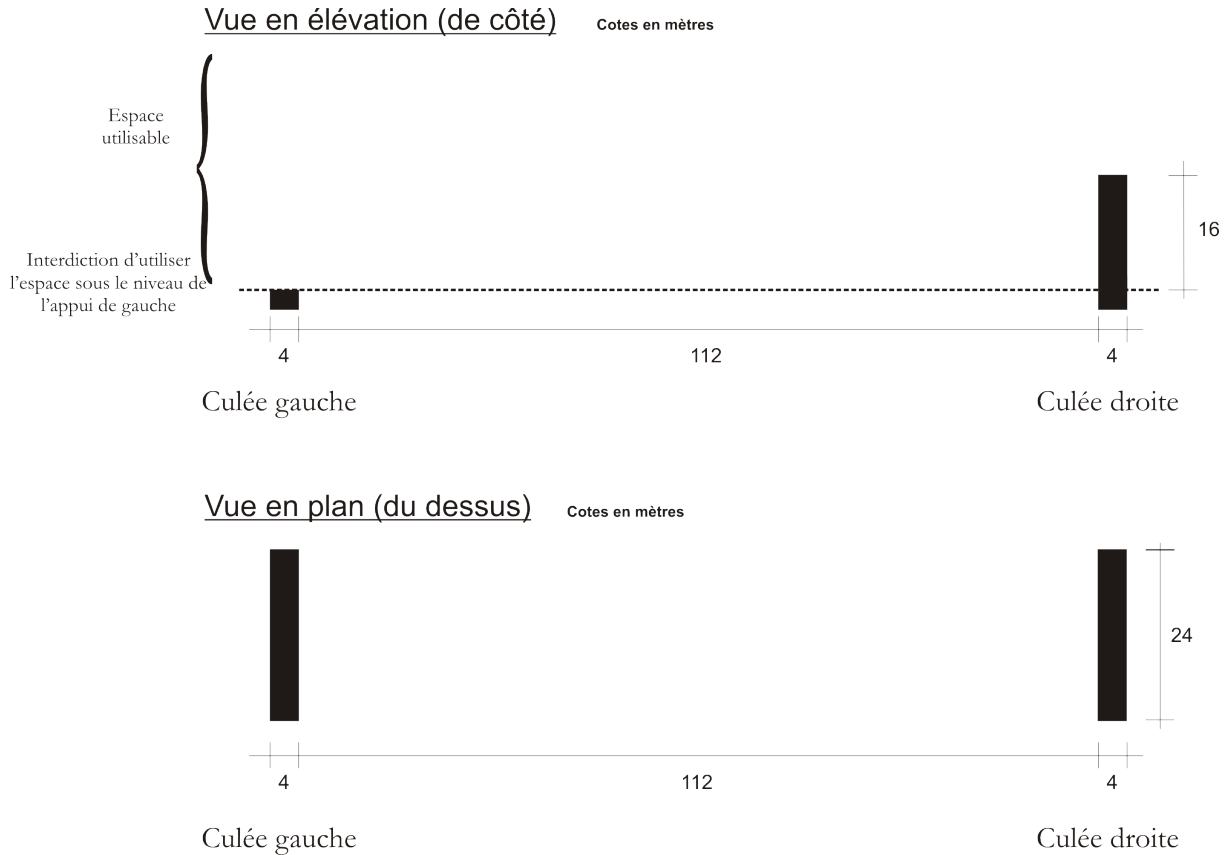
Vue en plan et en élévation des appuis (Cotes en mètres, échelle 1/100).
